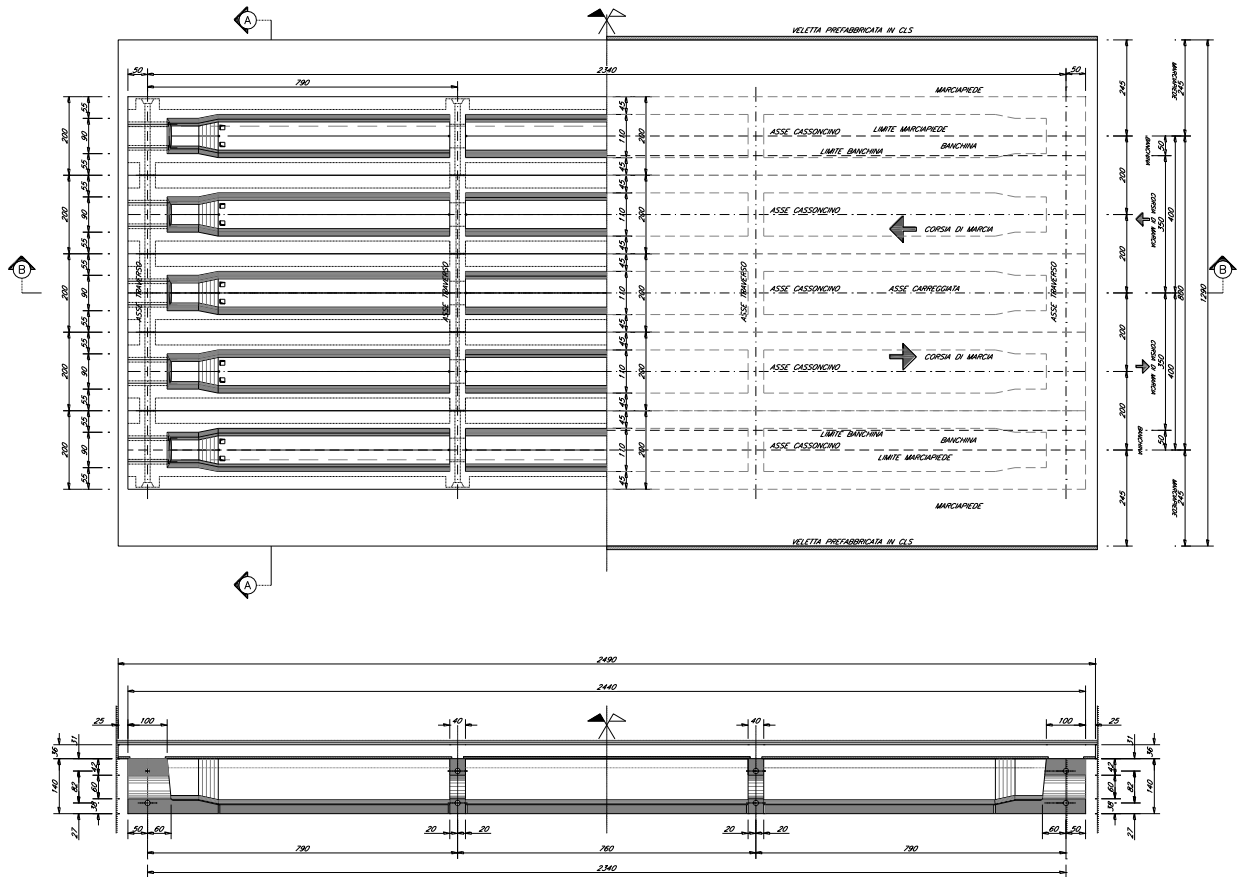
Sezione, pianta e vista impalcato del Cavalcaferrovia
